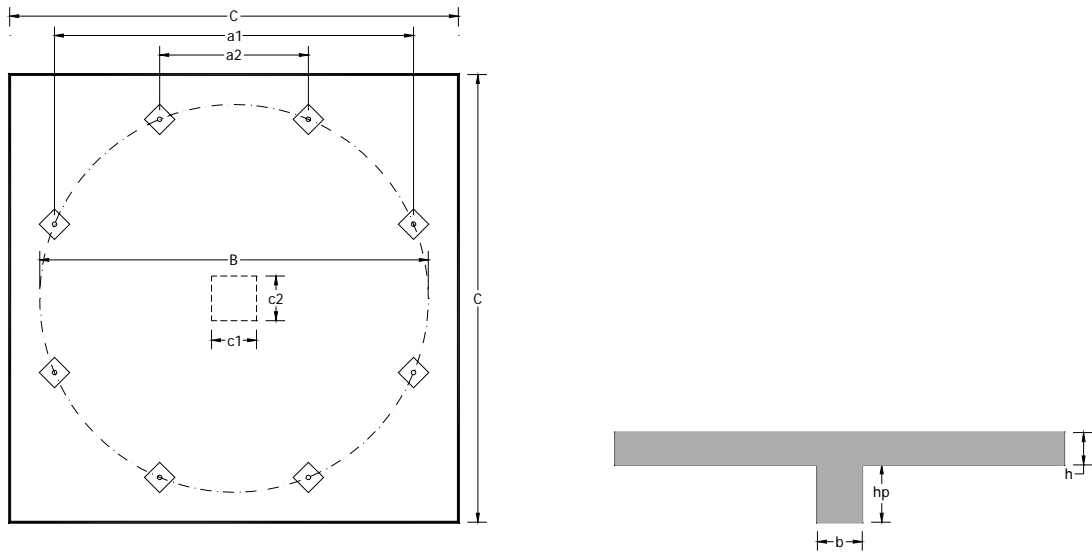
Geometria dos modelos de laje: planta e corte transversal.
